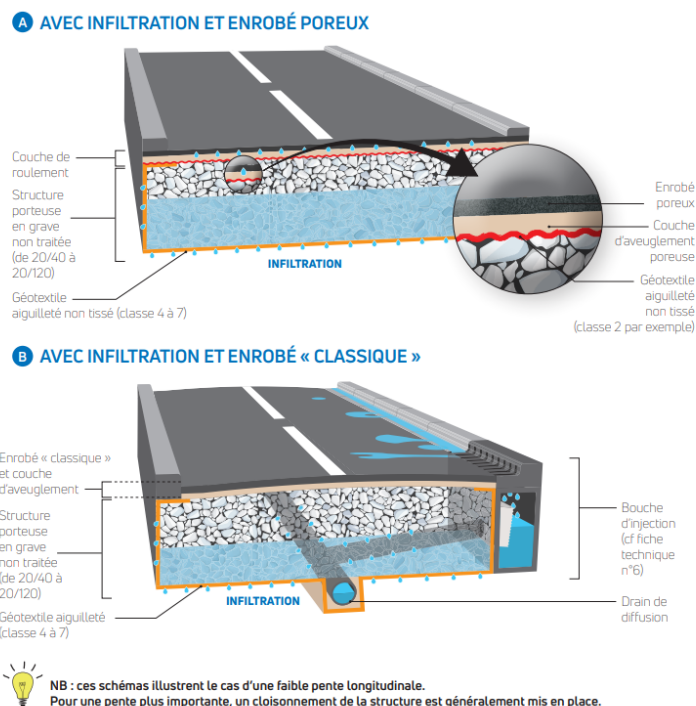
[Schéma d'une chaussée à structure réservoir](#)
